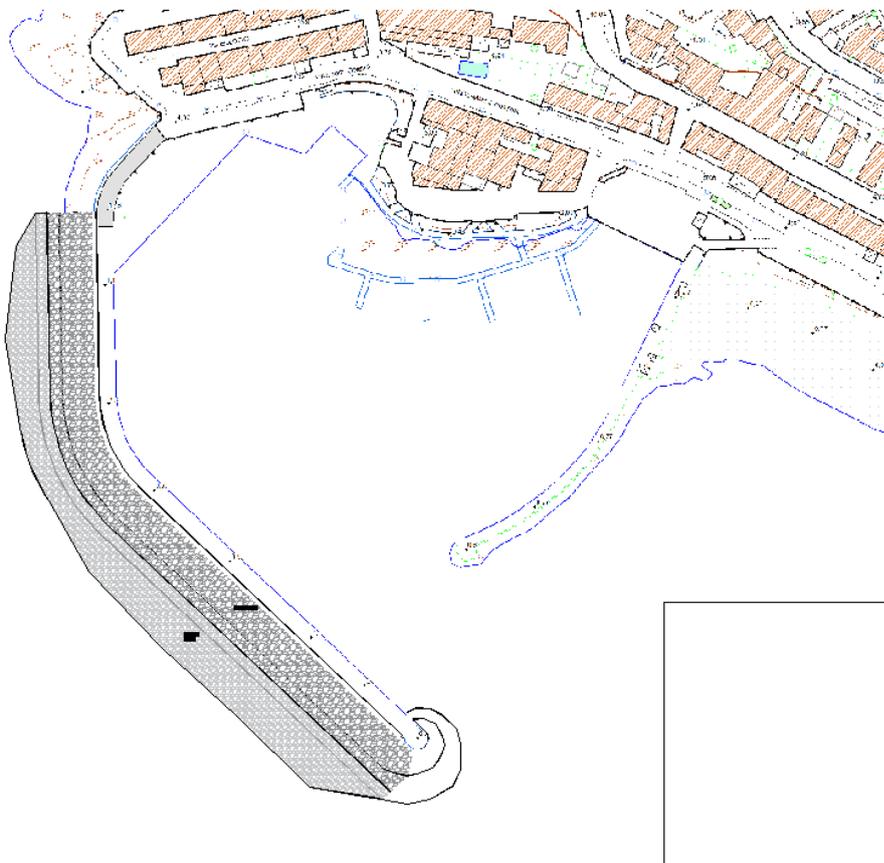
planimetria con indicazione sintetica degli interventi in progetto
